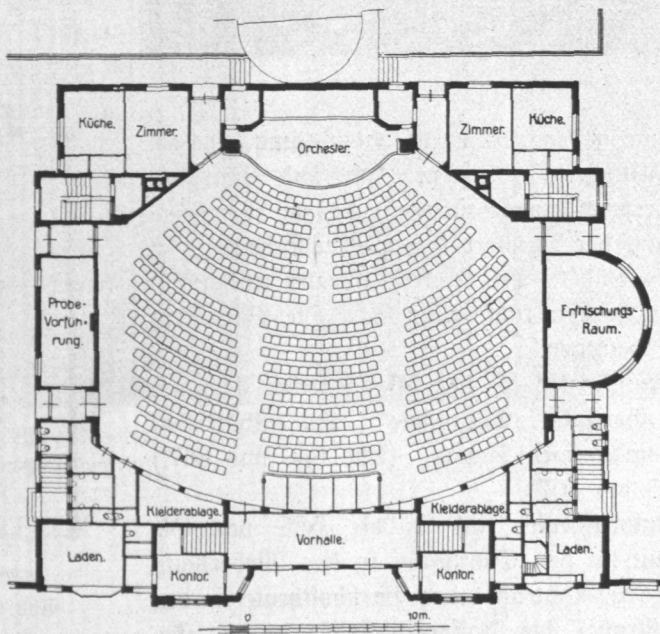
Lichtschau-Spielhaus am Millerntorplatz, Grundriß.
